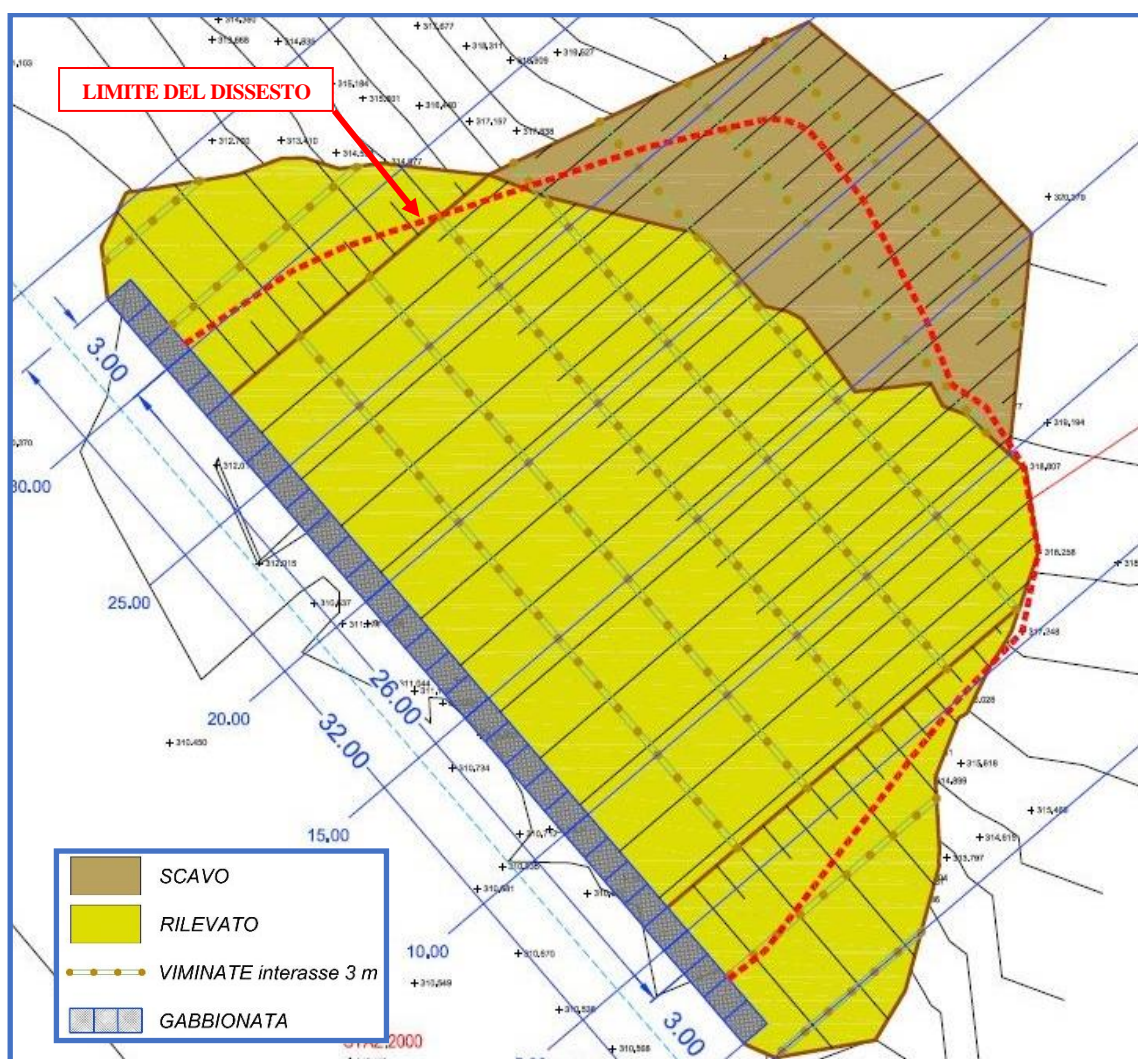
Zona intervento 2 – Planimetria dell'intervento
